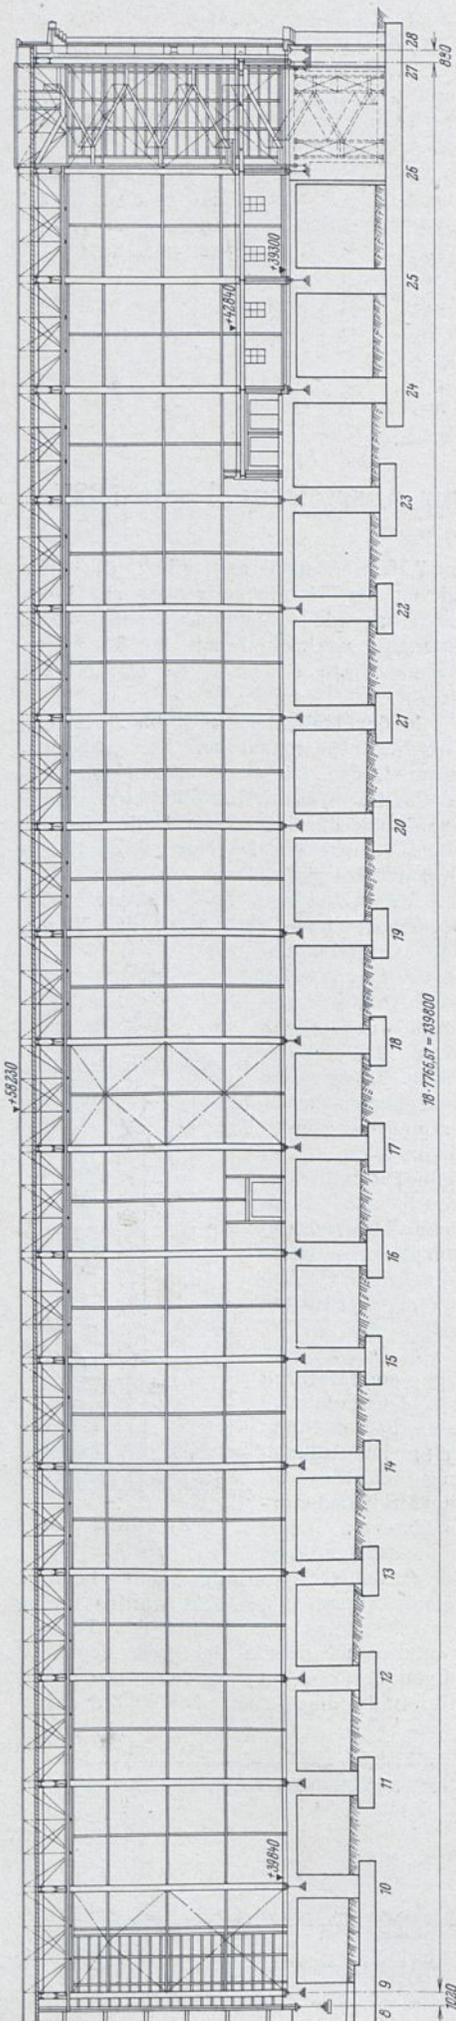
Längsschnitt durch die Halle vor der Rahmenachse y.
